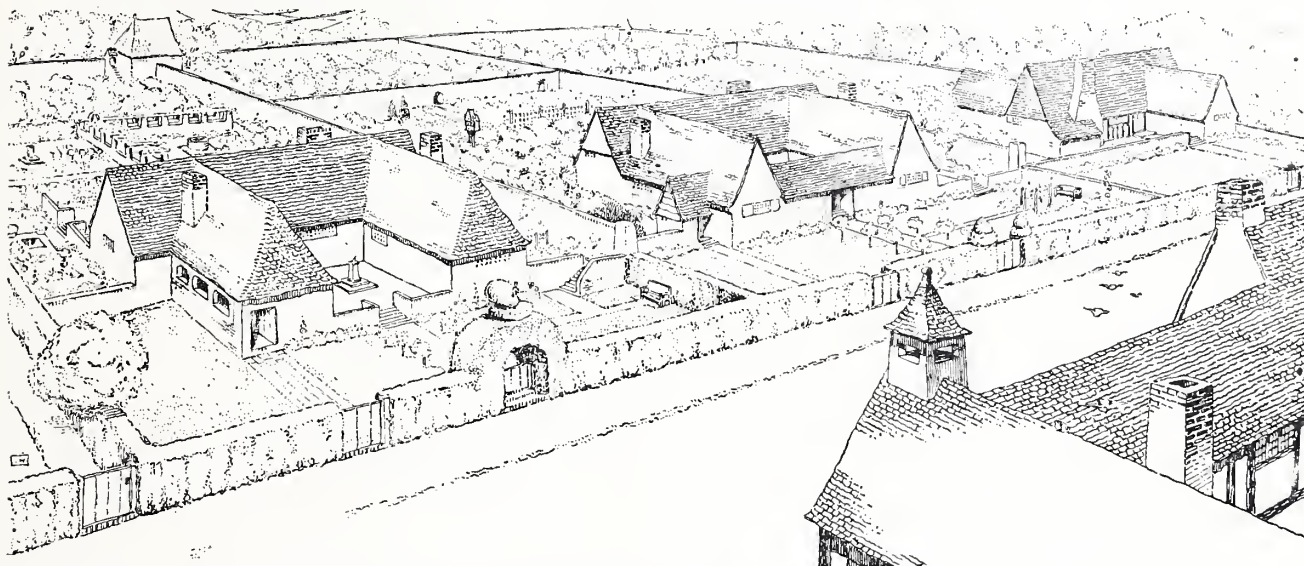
Garden Suburb Hampstead. Ebenerdige Häusergruppen mit größeren Gärten. Architekten: Barry Parker und Raymond Unwin
